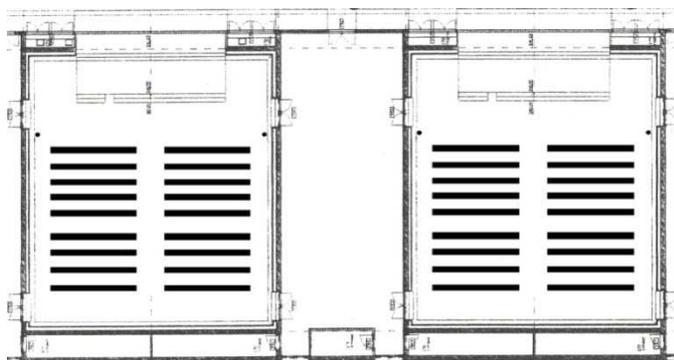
Planta da capela 1 (à dir.) e da capela 2 (à esq.).
